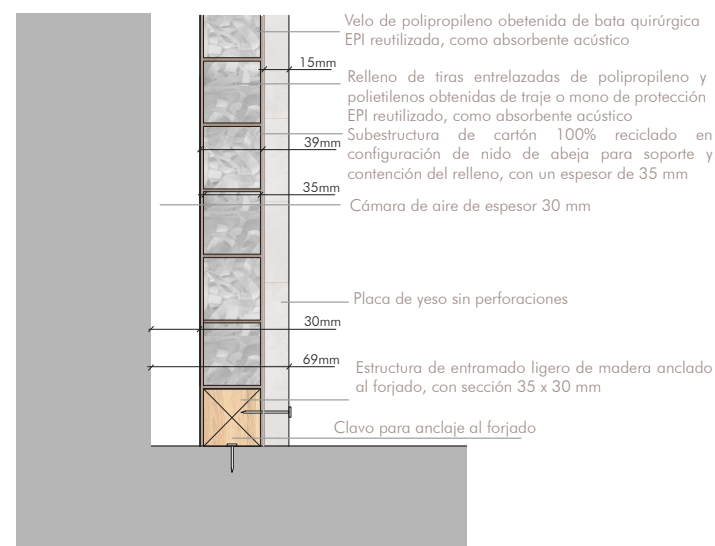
Detalle constructivo del encuentro entre el trasdosado sin perforaciones y el forjado por la cara superior. Fuente: elaboración propia
